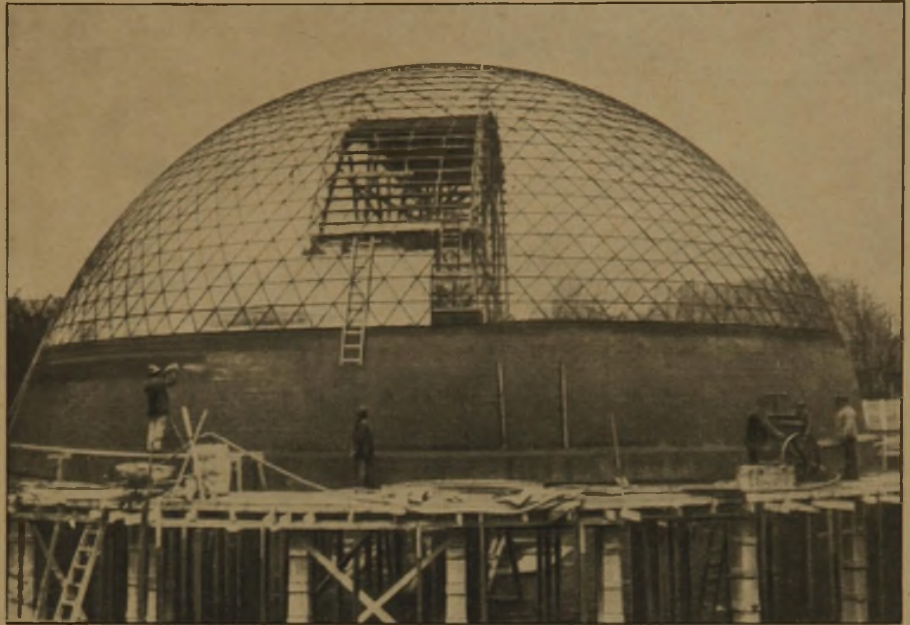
Fertig montierte Eisenbewehrung. (Im Innern leichtes drehbares Montagegerüst.)
